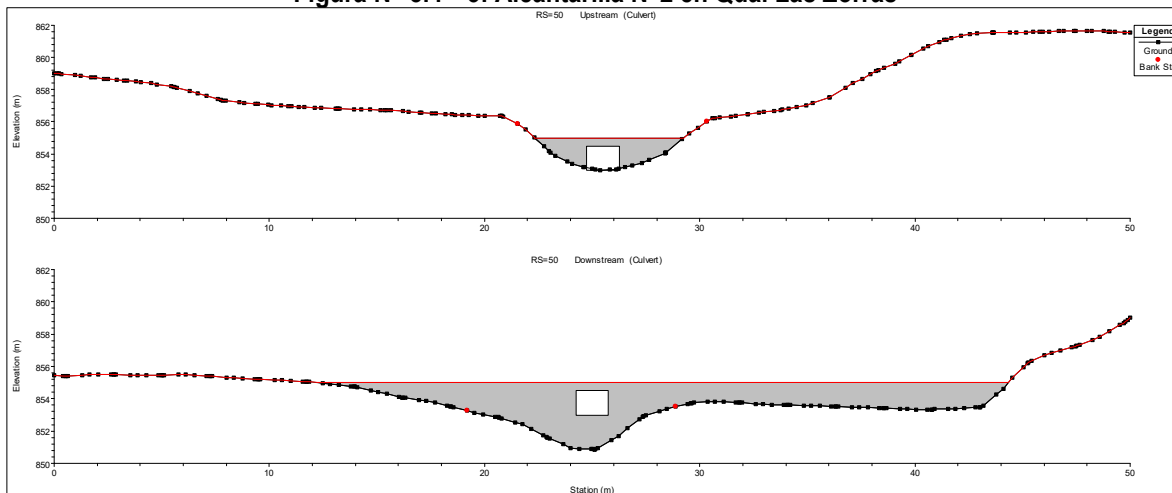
2: Alcantarilla N°1 en Qda. Las Zorras, cauce norte
